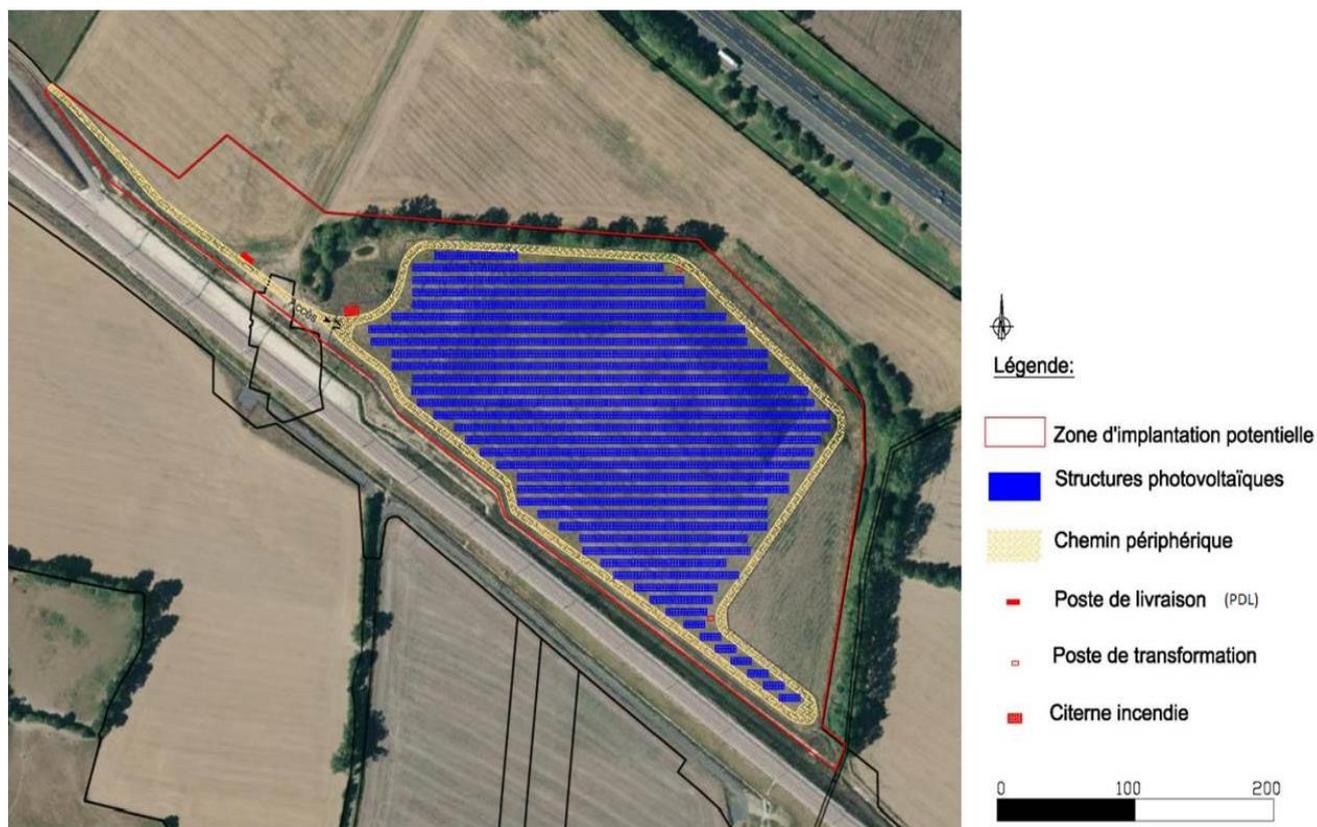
Plan de Masse - Centrale Solaire ARGENTRE
